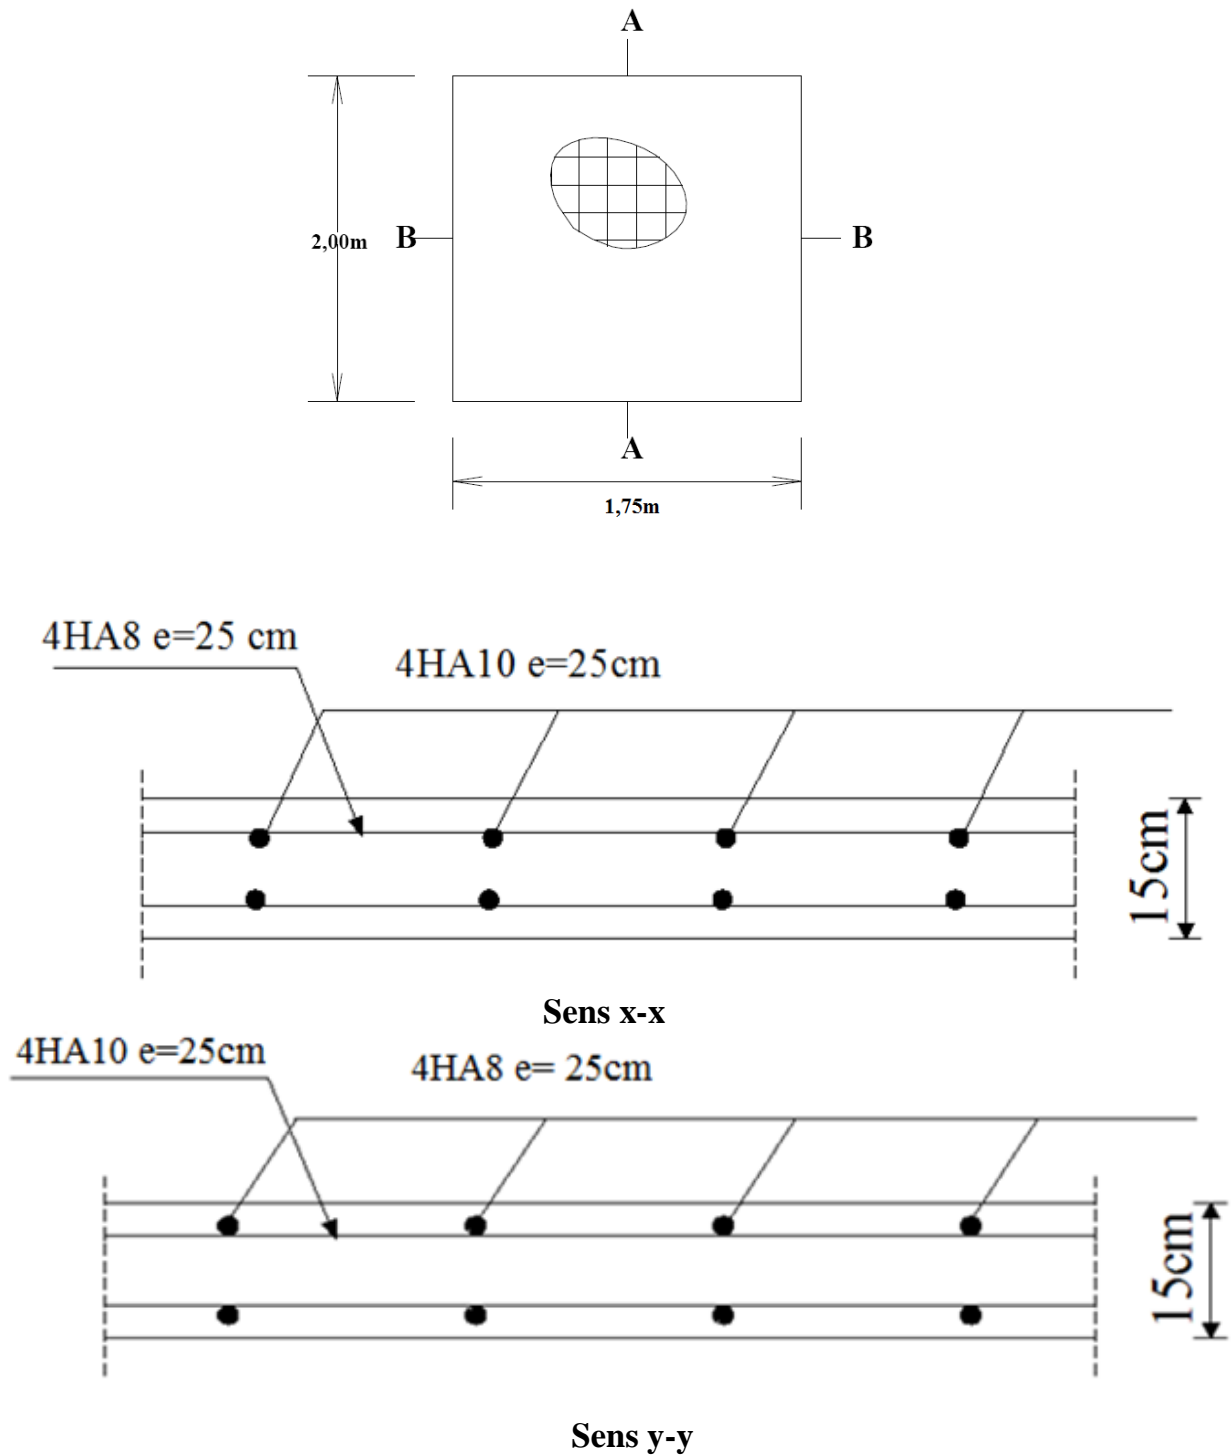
Ferrailage de la dalle pleine de la salle machine
